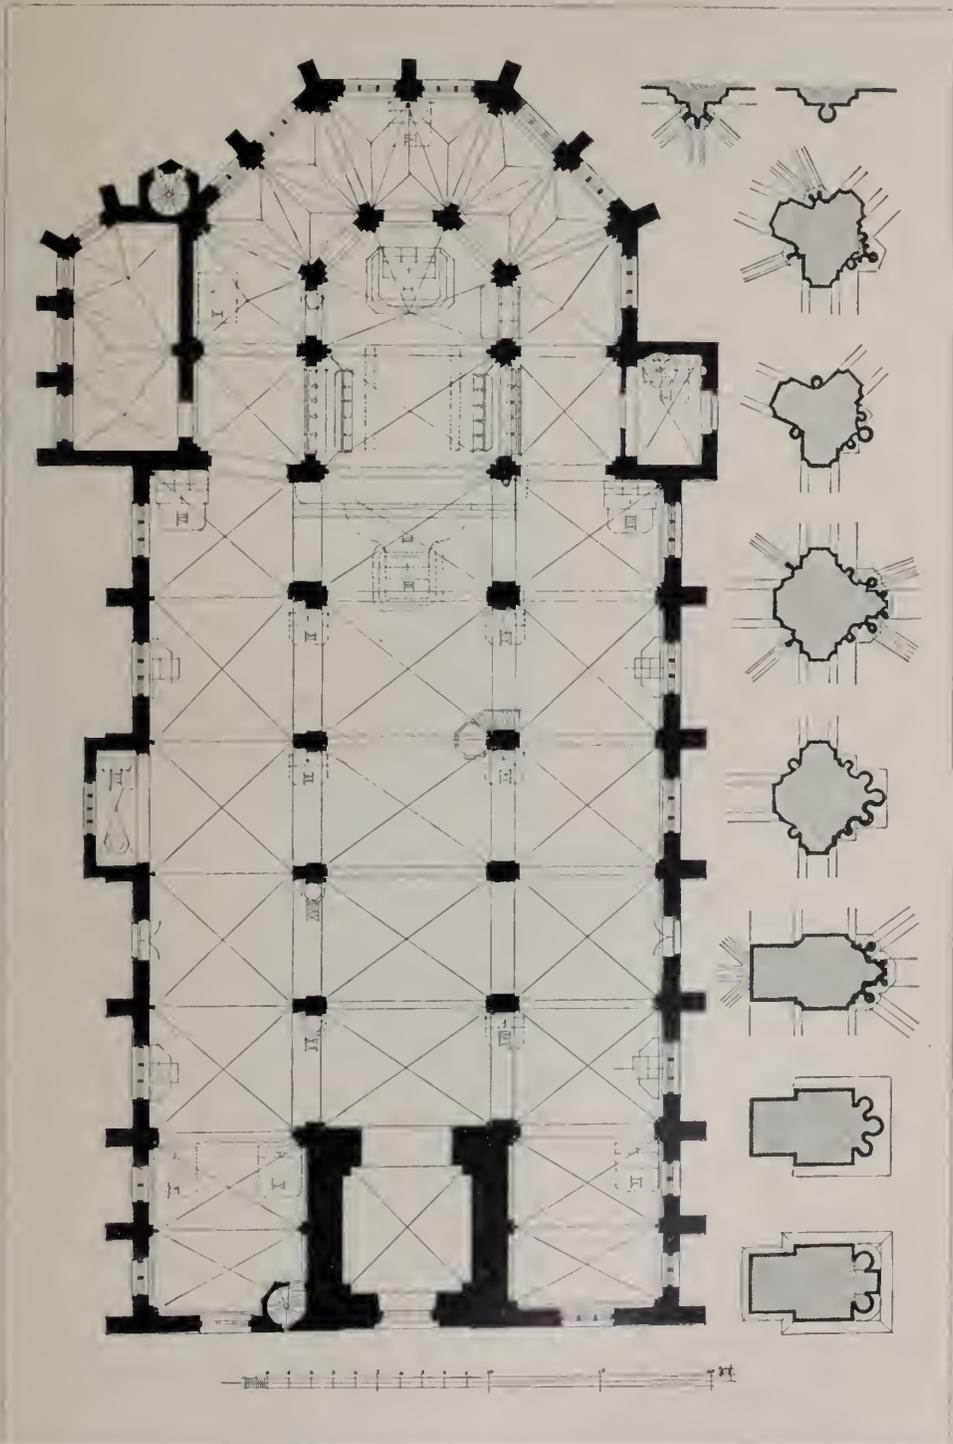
Kempen. Grundriss der Pfarrkirche.
